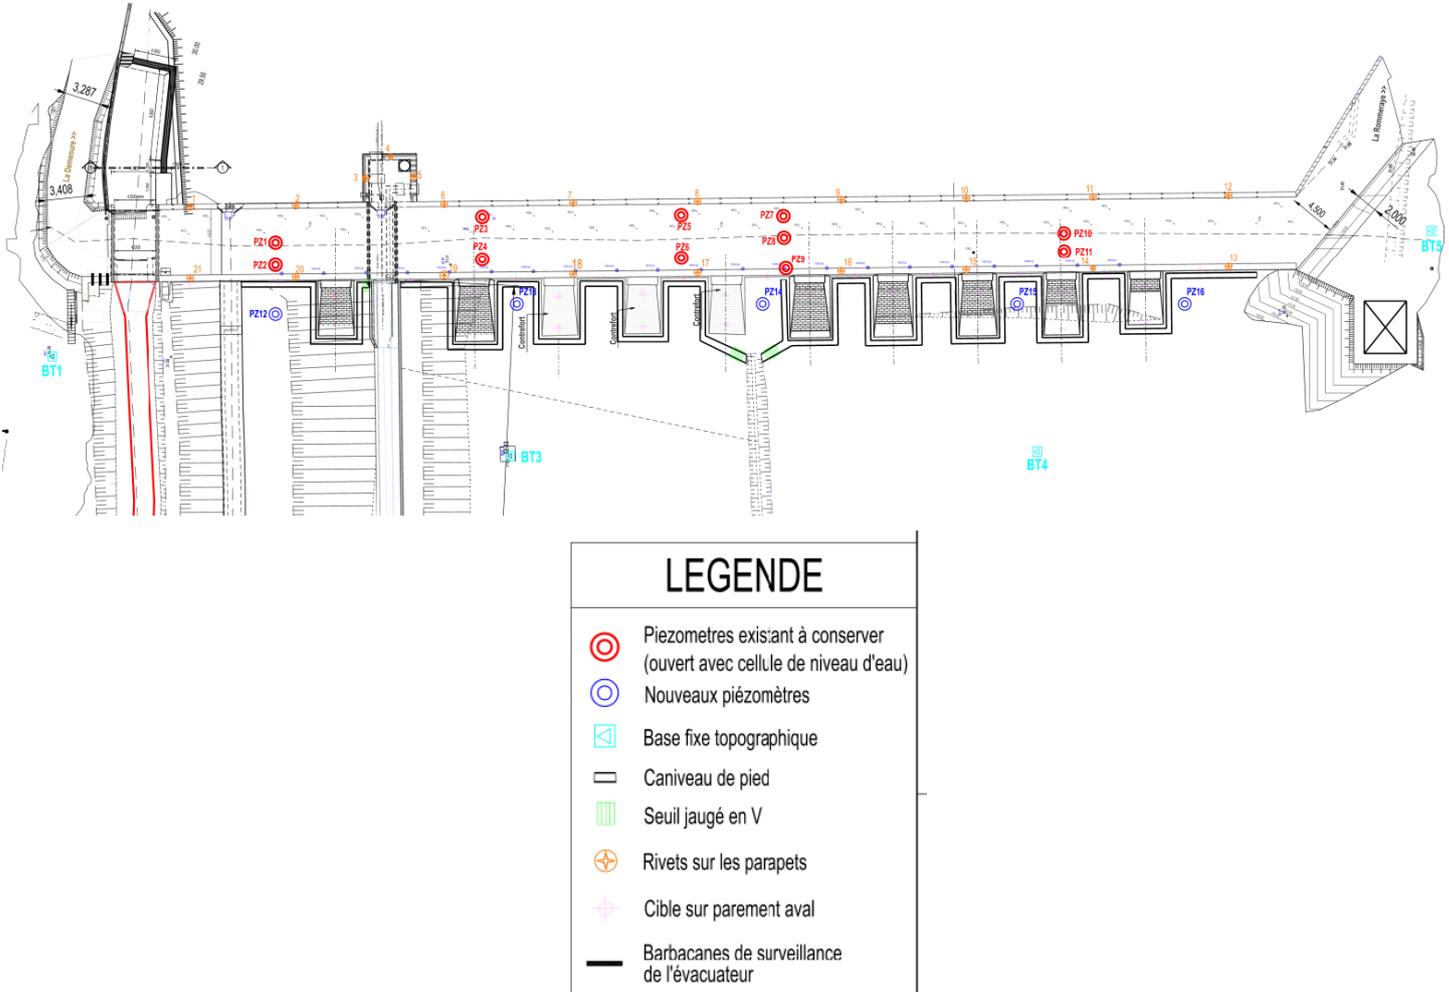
Extrait du plan d'auscultation de l'AVP
